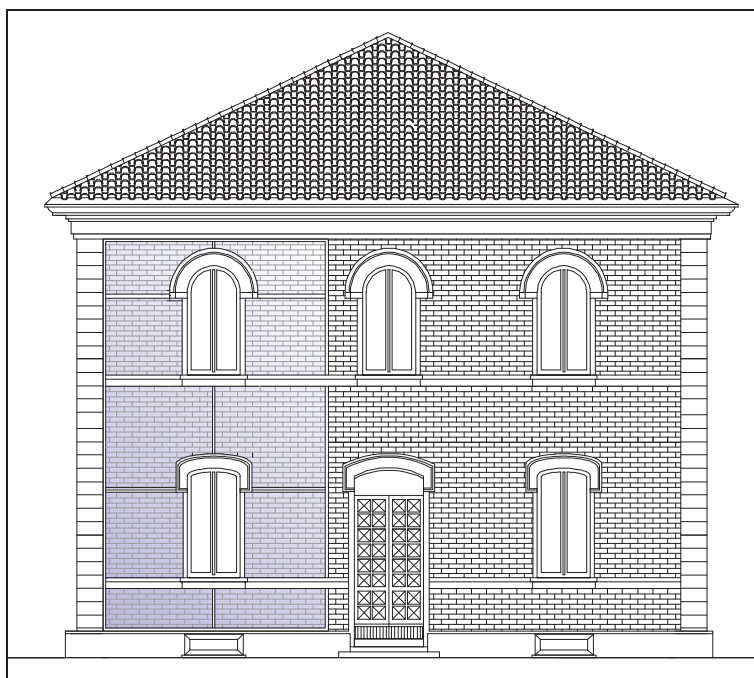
Caso di studio – Strategia b) Prospetto sud con muro a effetto serra.
